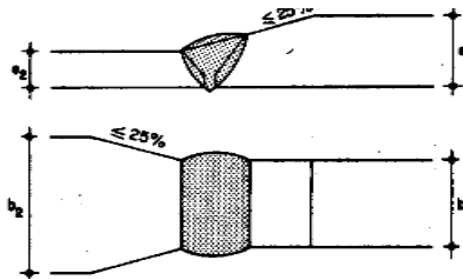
A Soldadura a tope de chapas de distinta sección
